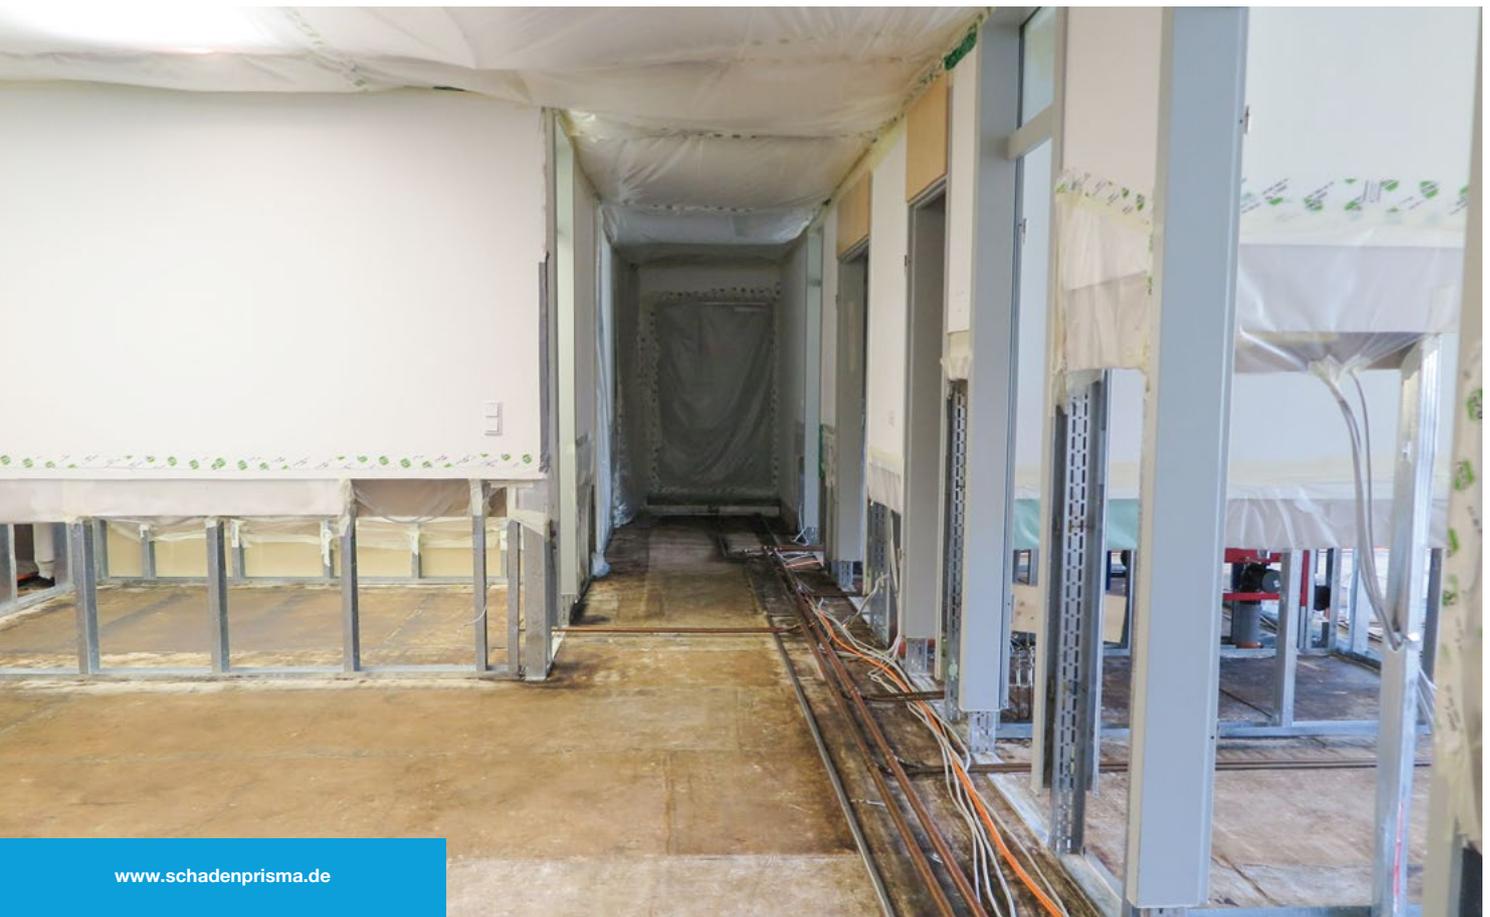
| Hauptsächlich betroffener Küchenbereich mit der Ablaufrinne
